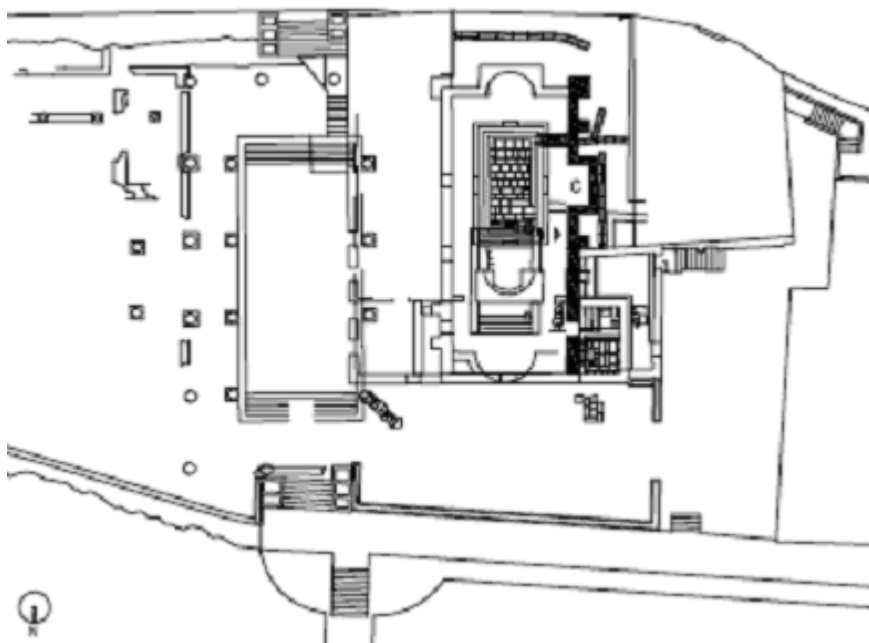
Planta e interior da parede C, a oeste (Frade, 2000).
